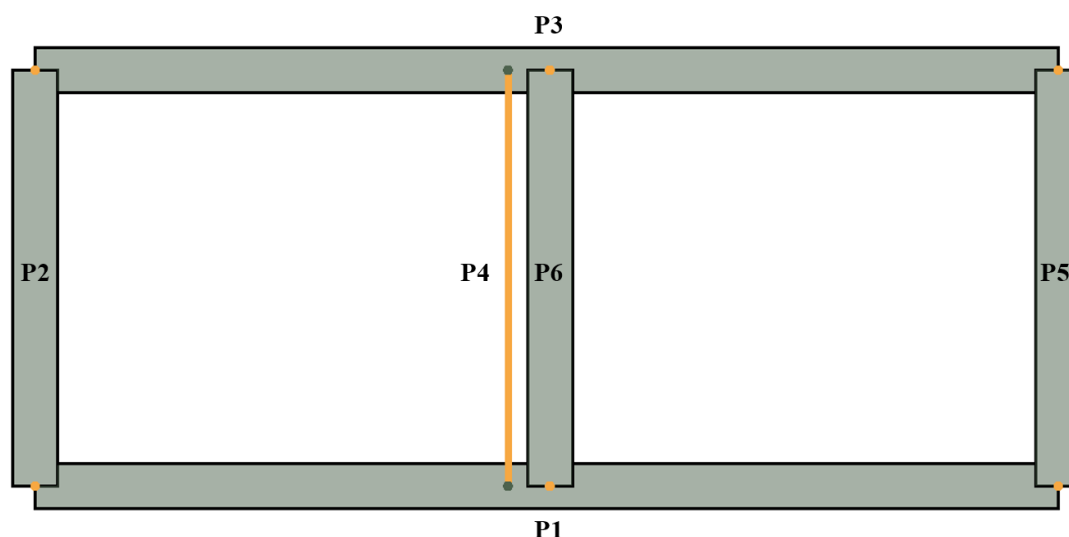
Pianta con indicazione delle pareti - Modello Scollegato
